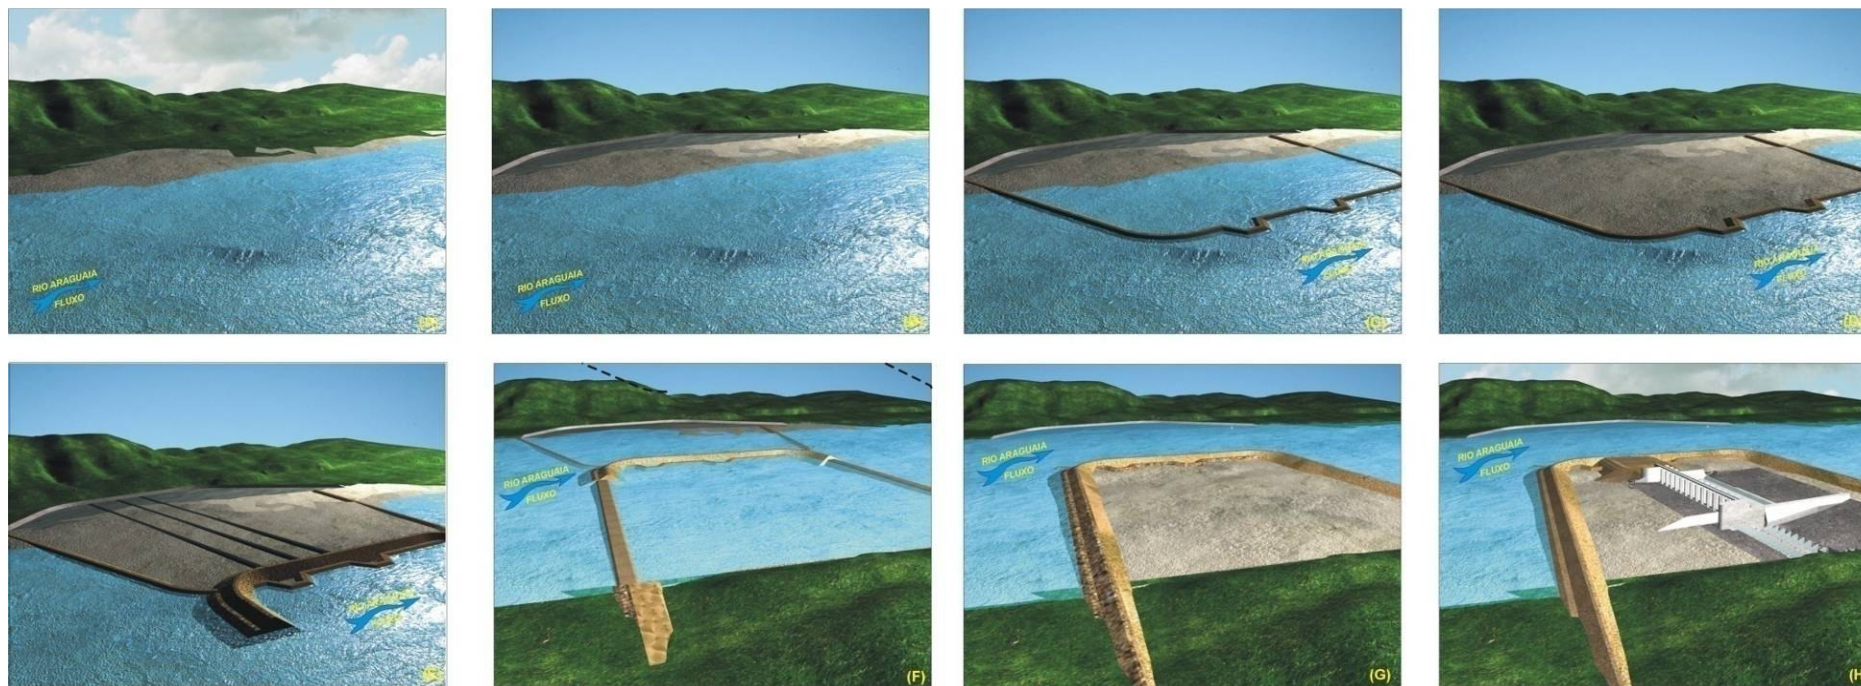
Sequência construtiva da barragem- primeira fase.
